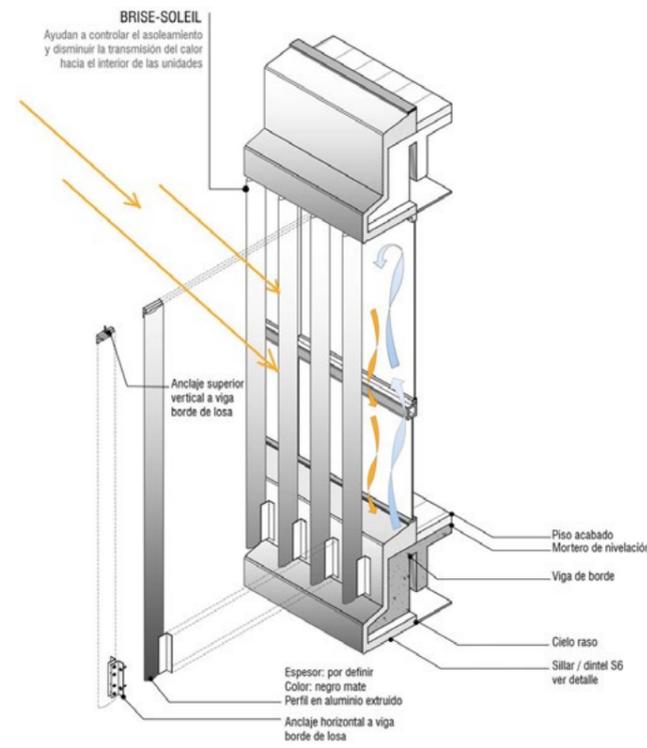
Sección constructiva isométrica. Fuente: Obranegra Arquitectos.
